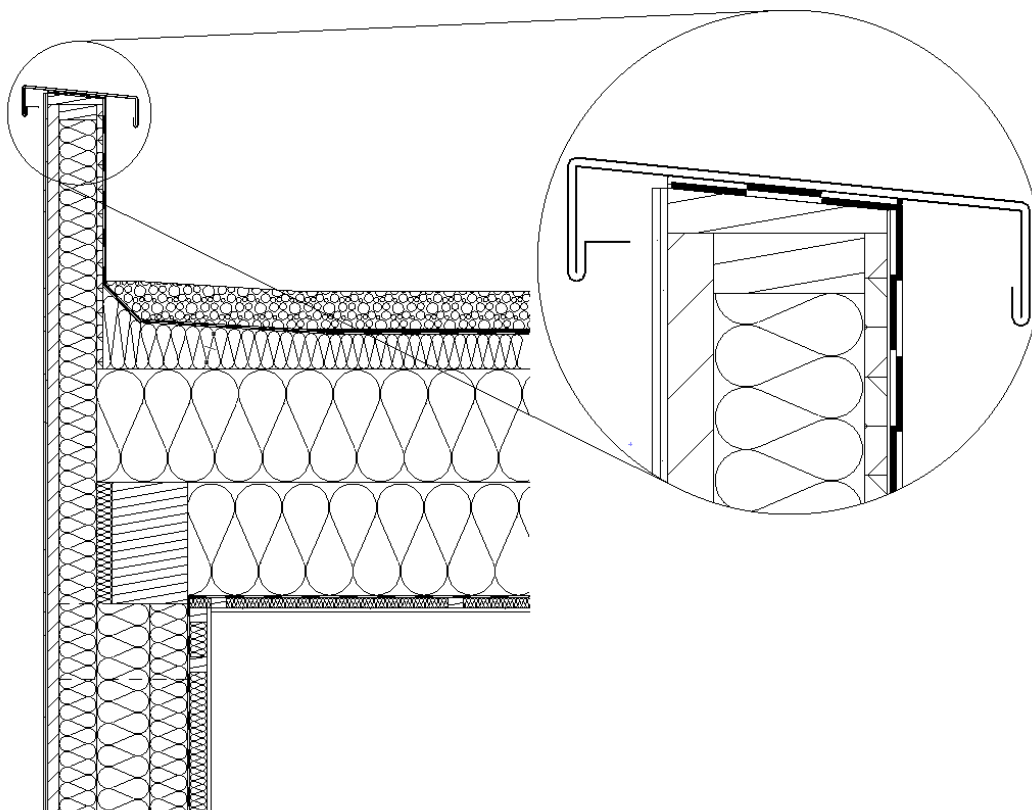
Detail styku stěny a stropu nad nevytápěnou zónou Dřevěného masivního skeletu v měřítku 1:20
